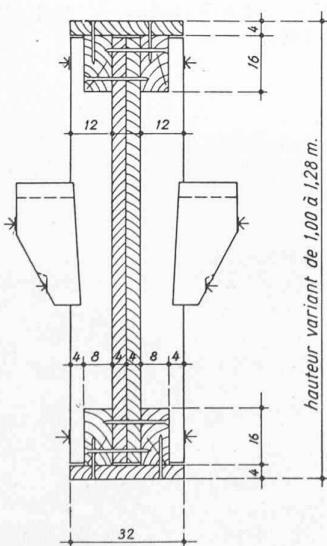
Cortaillod. Coupe transversale d'une ferme en I. 1 : 20.
